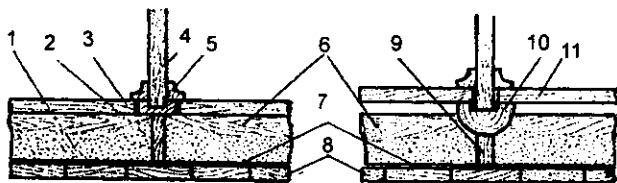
Перегородка располагается поперек балок и опирается прямо на балки или лаги
